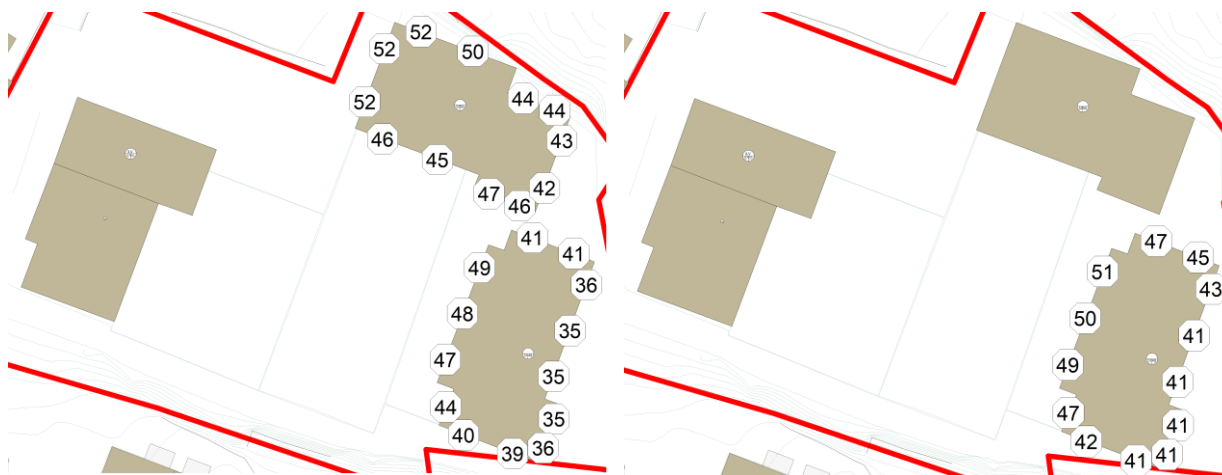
Innfallende lydnivå (L_{den}) ved fasade, plan 4.
